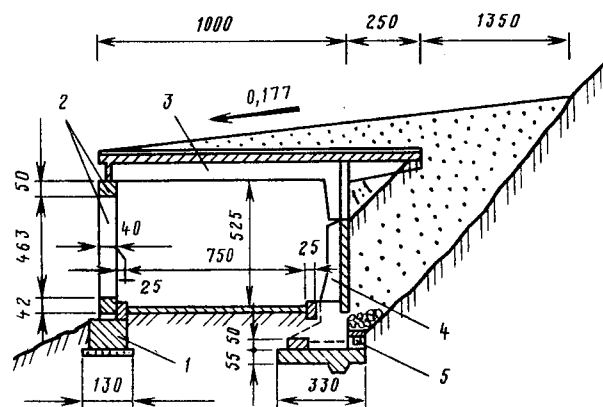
Поперечный разрез противолавинной галереи: 1 — фундамент низовой опоры; 2 — блок низовой опоры; 3 — блок перекрытия; 4 — блок верховой опоры; 5 — дренажная система
